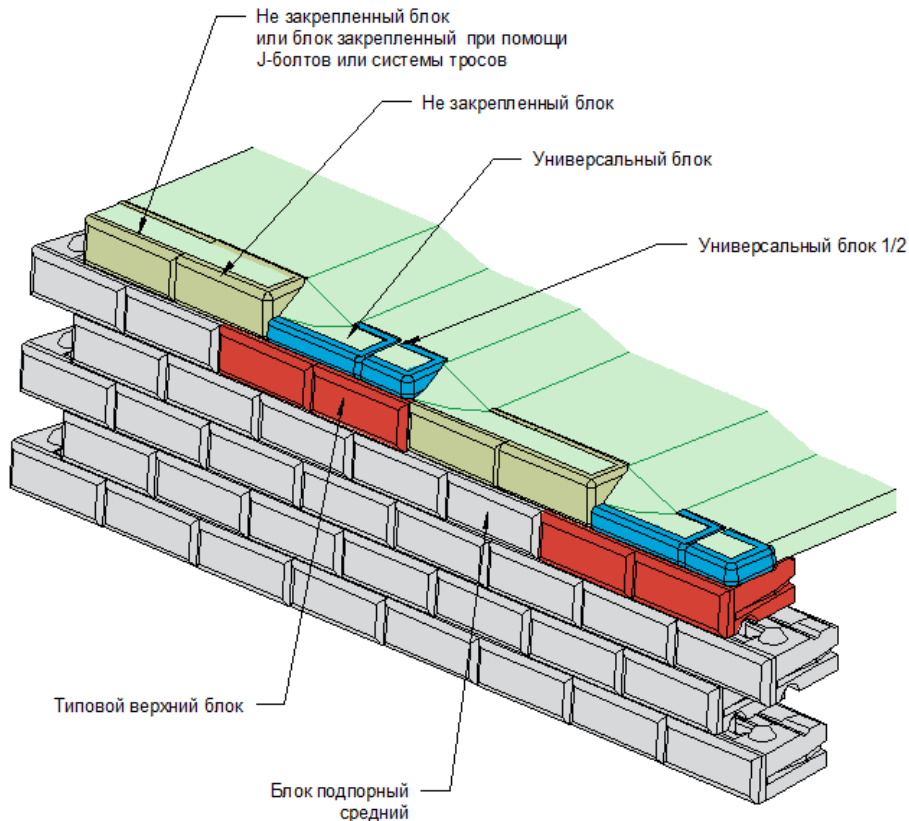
Пример установки блоков верхнего ряда для компенсации перепада планировочных отметок
